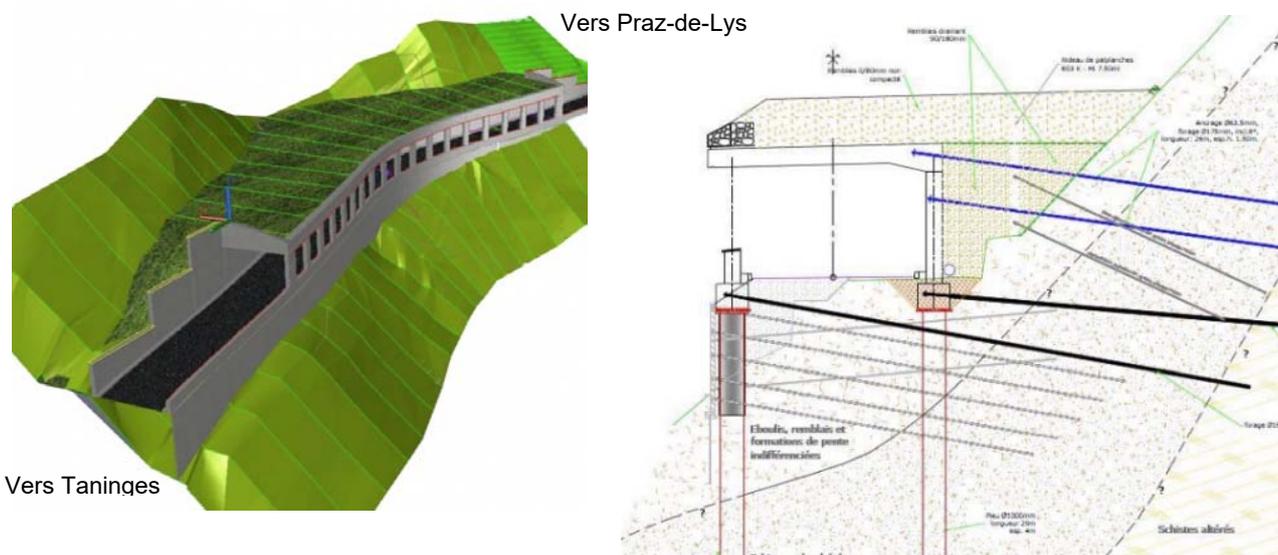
a) Vue 3D de la galerie b) vue en coupe galerie et de ses fondations
